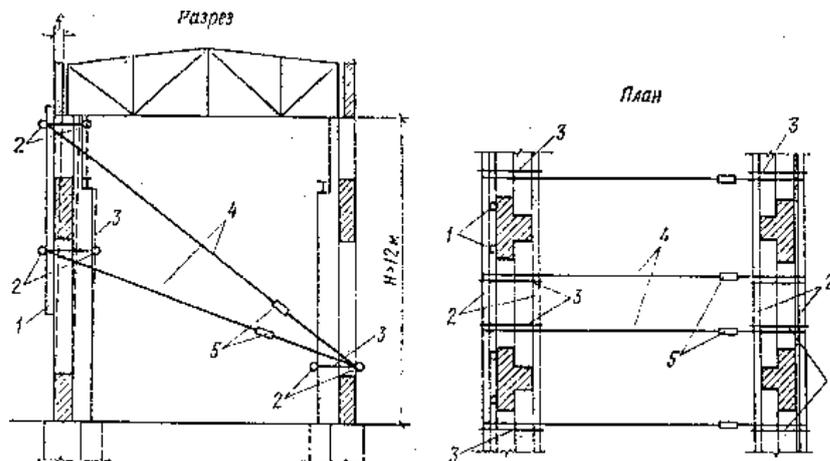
Крепление отклонившейся или выпучившейся стены стальными стяжками (расчалками)
